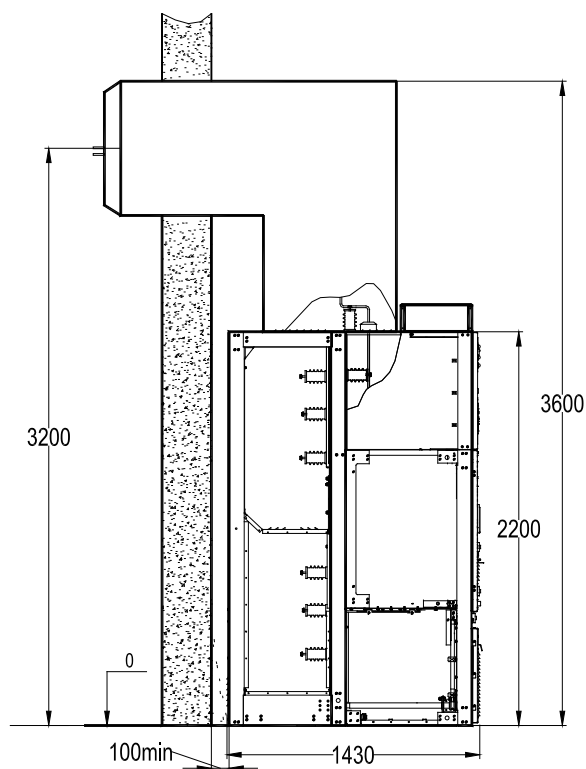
Размещение шкафов фасадом от стены здания
